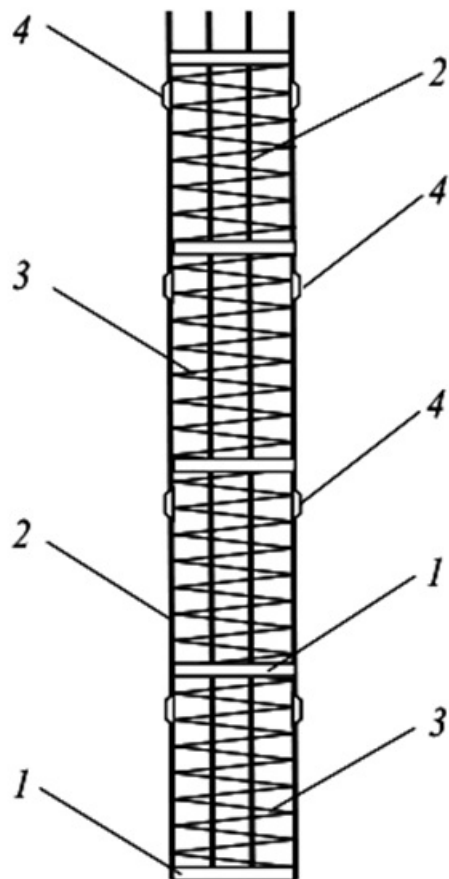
Конструкция арматурного каркаса буронабивной сваи:
